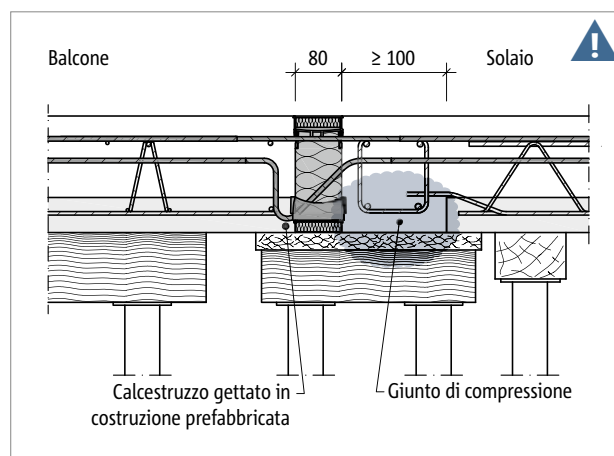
Schöck Isokorb® T tipo K-F: montaggio con solette semiprefabbricate (qui: $h \leq 170$ mm), appoggio indiretto, giunto di compressione lato solaio
